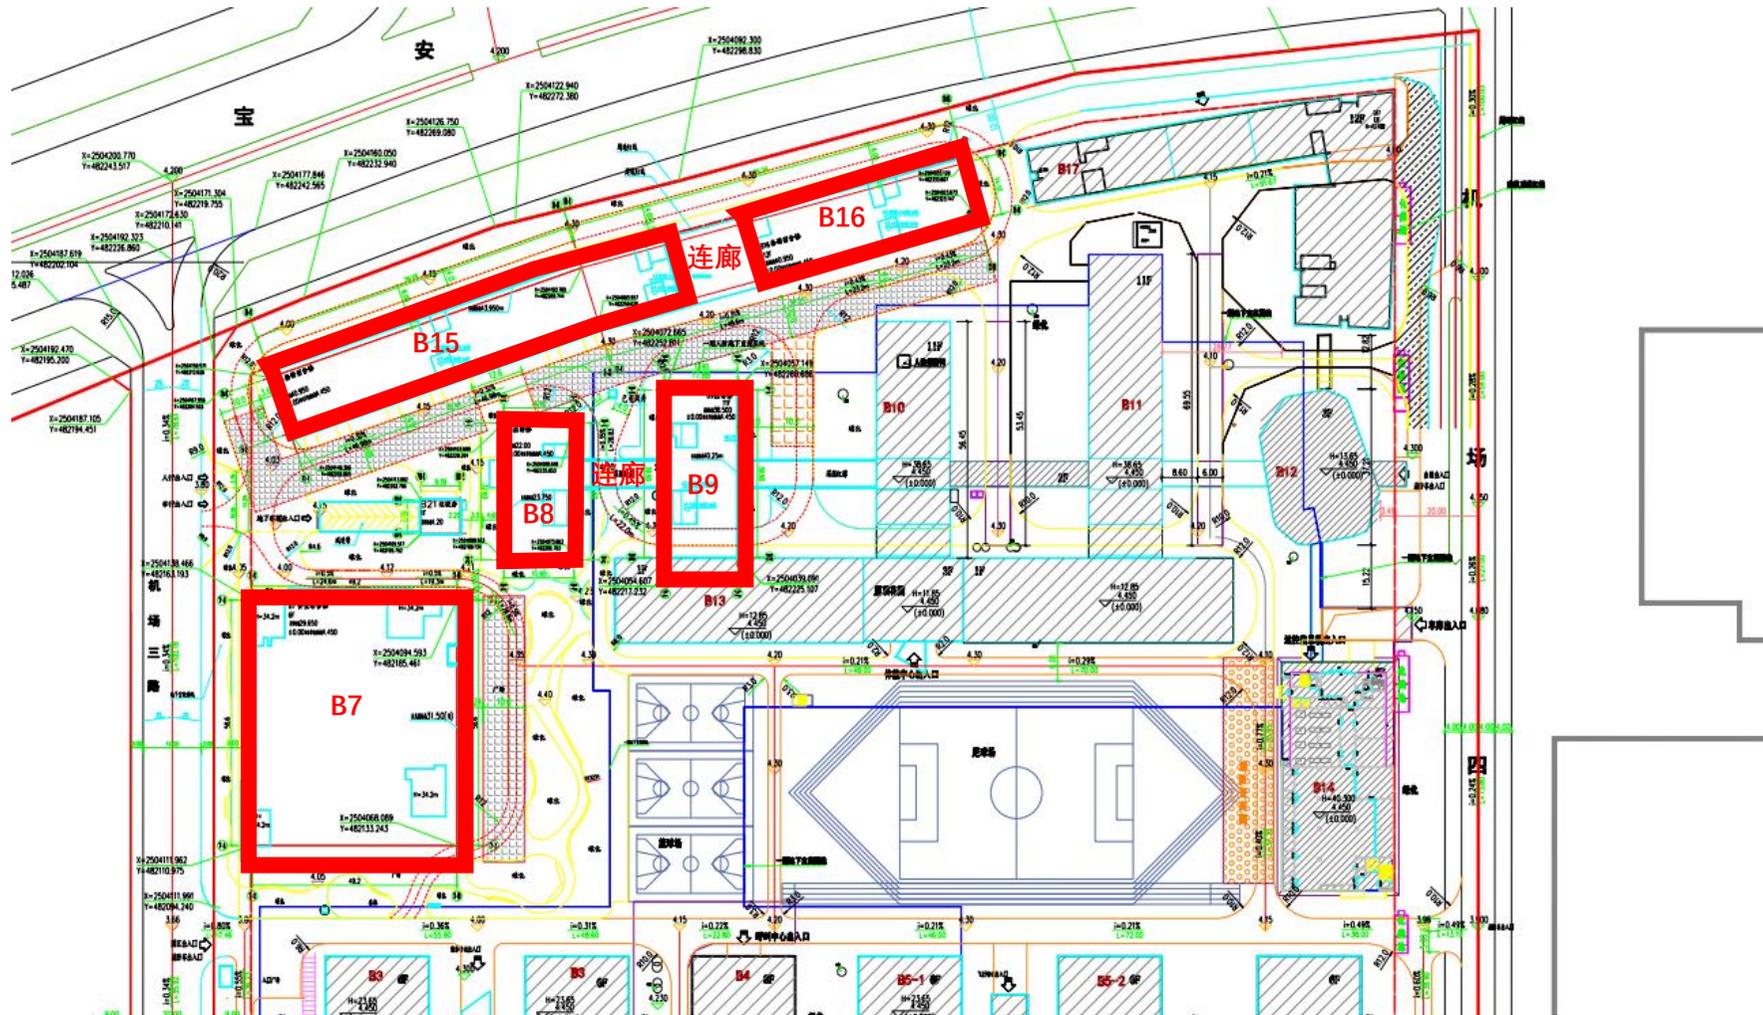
深航总部东区三期工程 (B7、B8、B9、B15、B16) 平面布置图
